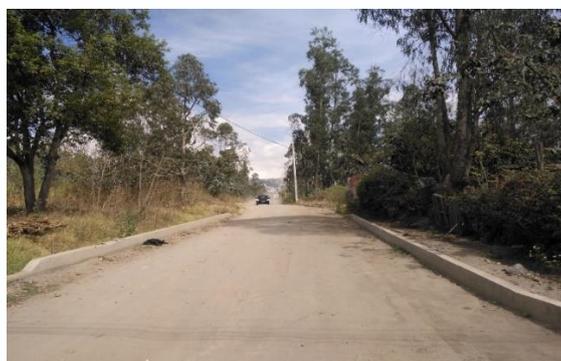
CALLE ELOY ALFARO DELGADO
